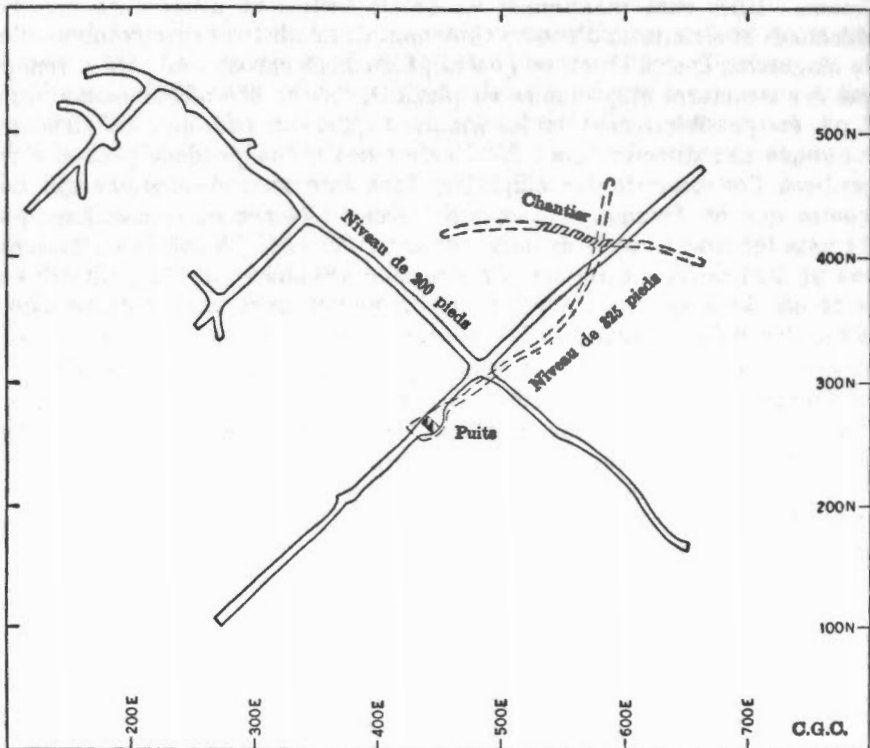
Plan combiné des étages de 200 et de 325 pieds à la mine Randall; en tout 1,600 pieds de galeries et de travers-bancs ont été aménagés sur le niveau de 200 pieds, et 490 pieds au niveau de 325 pieds.
